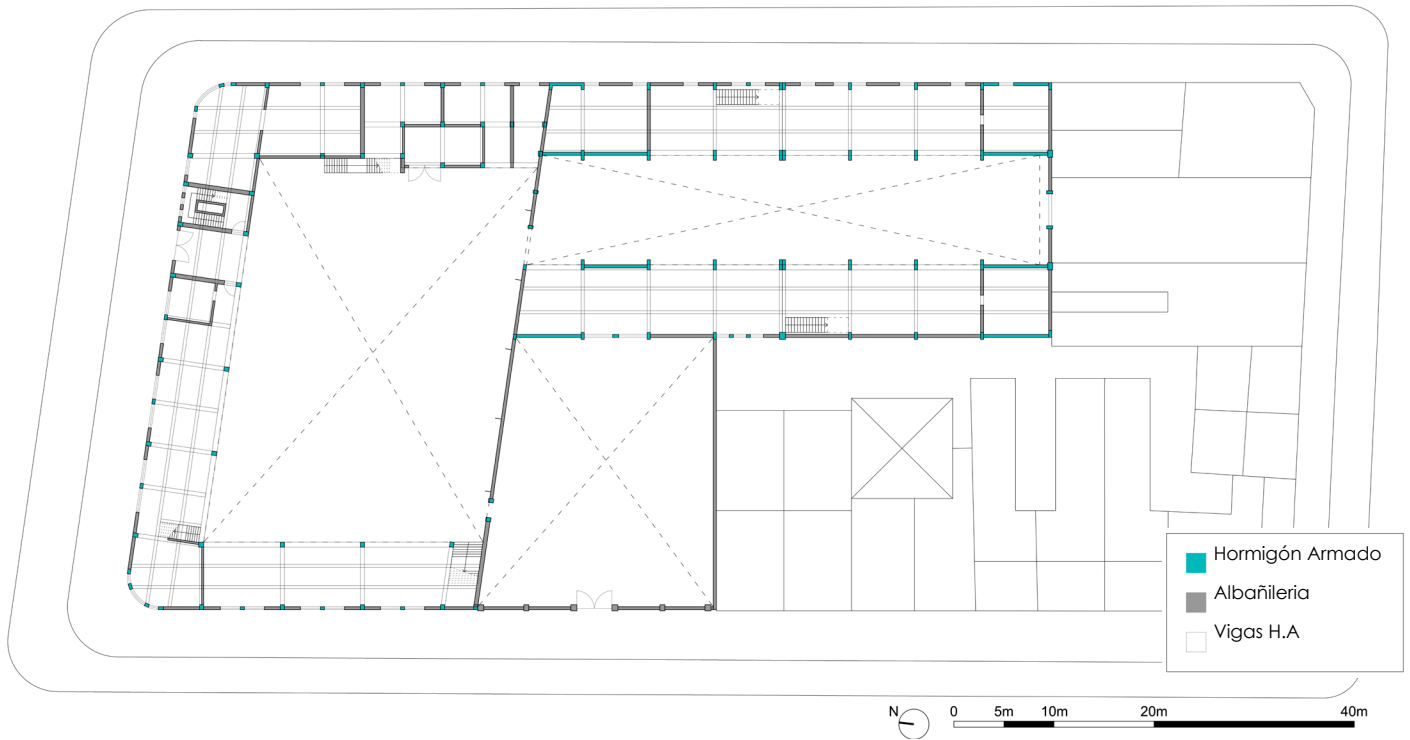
Planta Nivel 1 Ex Fundición Metalco. Fuente: elaboración propia.
